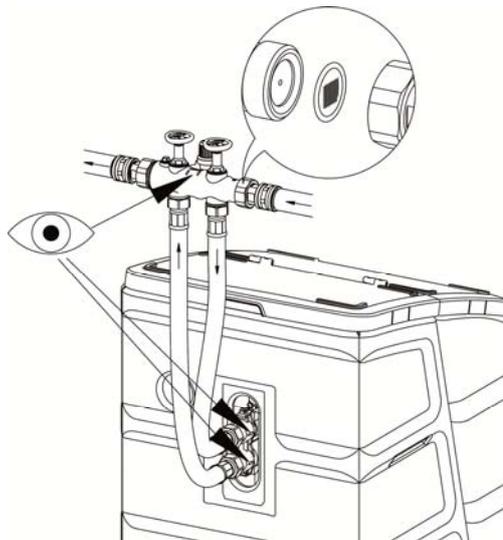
Collegamento dell'impianto sanitario Weichwassermeister® GSX
